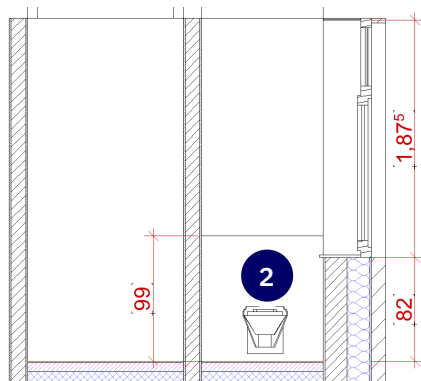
· Schnitt durch den Raum: Vorwandhöhe, Fußbodenaufbau und maximale Fliesenhöhe ablesen.
